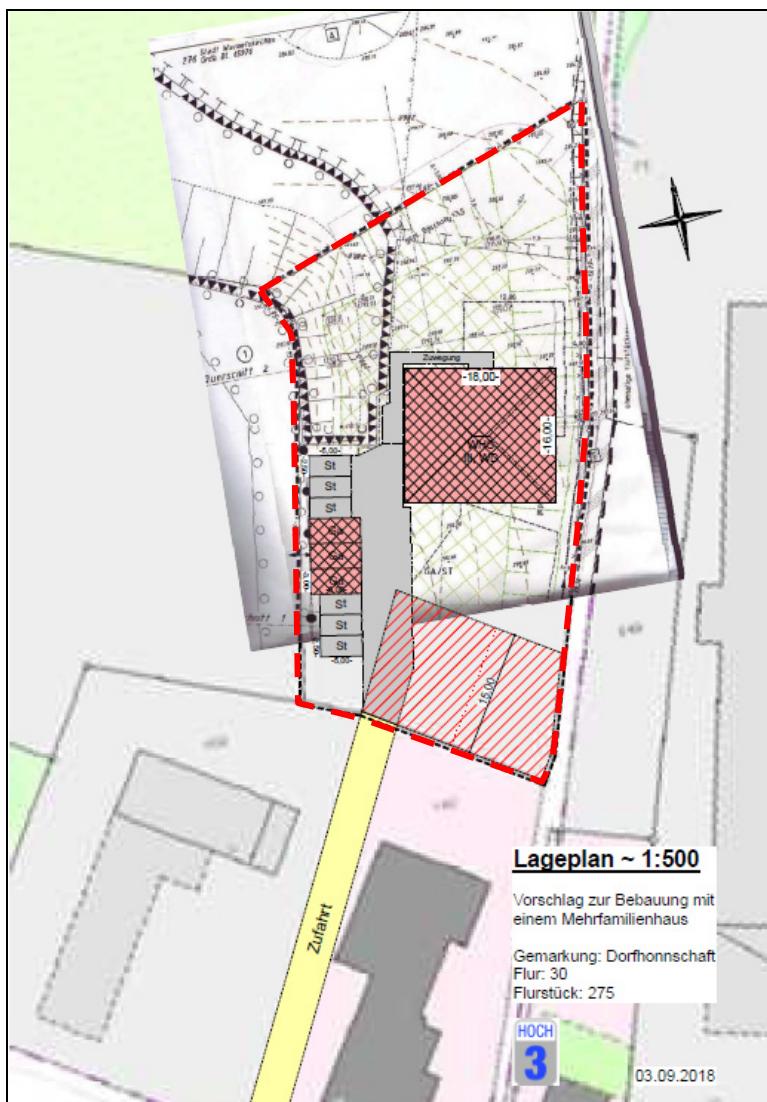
Ausschnitt des rechtskräftigen Bebauungsplans 48 „Ostringhausen“ mit Bebauungsvorschlag (Lageplan v. 03.09.2018) und Kennzeichnung des Grundstücks
